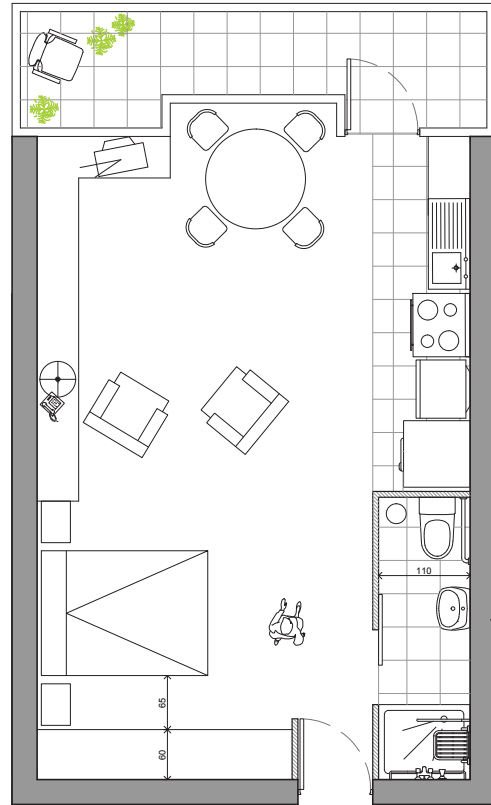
Planta s/e Tipología 1D. Distribución perimetral del programa. Elaboración propia. (planimetrías en desarrollo)
